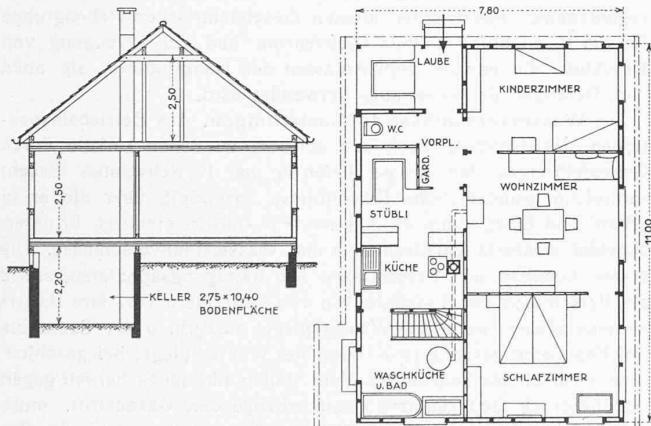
Schnitt und Grundriss des Kleinhauses. — Maßstab 1:200.
